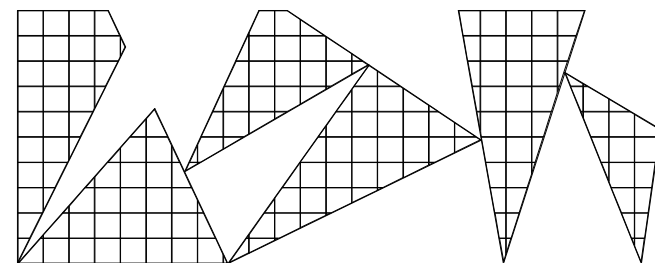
Esquema de muro extensivo, CANEVAFLOR.
